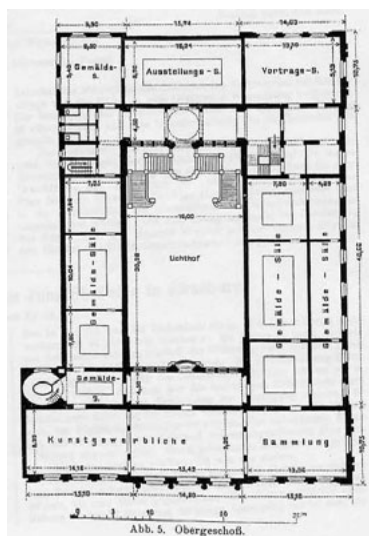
(上) ポーゼンのカイザー・フリードリヒ・ムゼウム2階平面図
